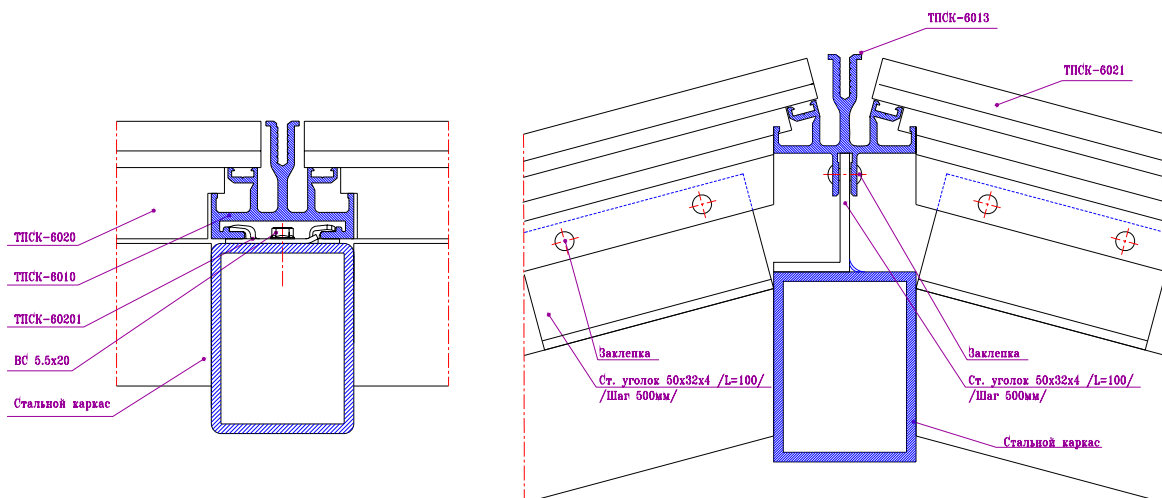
Каркас из стальных труб 60х60 и/или 60х80, соединяемых сваркой
